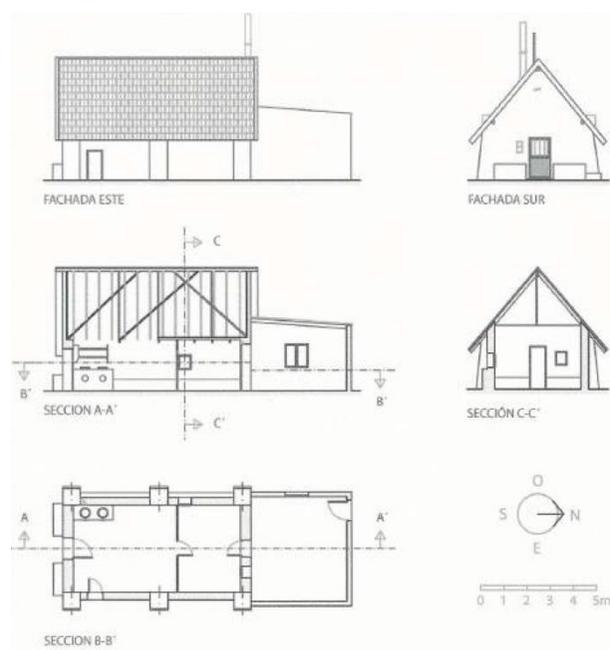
Planos barraca Pedro Paredes. Fuente: Rodríguez Casos, AM (2008). Las Barracas de la huerta de Orihuela
